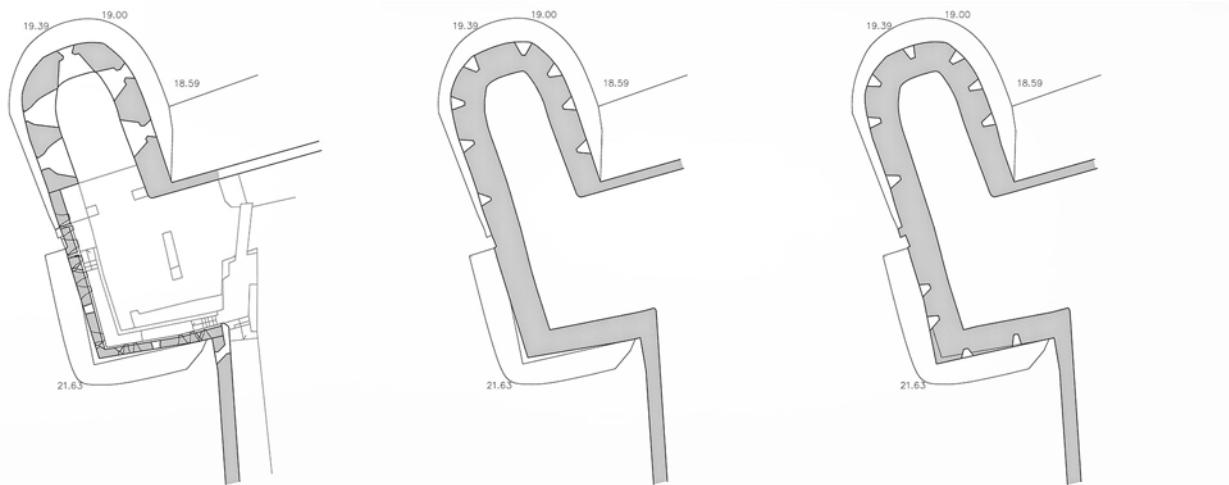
Secções horizontais do Baluarte do Raio. / Plans horizontaux du Bastion du Raio.
